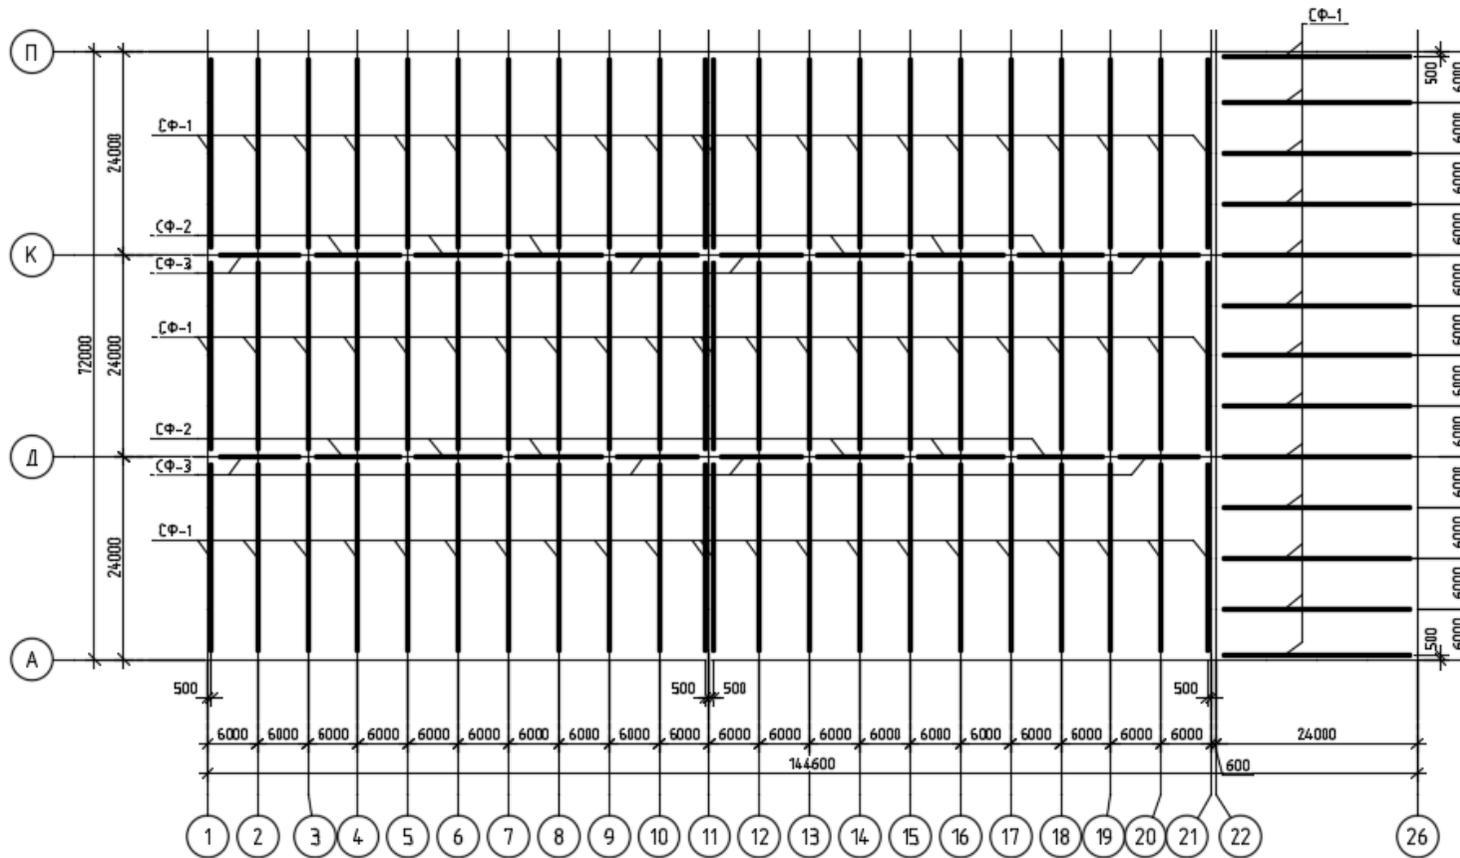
Схема расположения подстропильных и стропильных ферм покрытия
